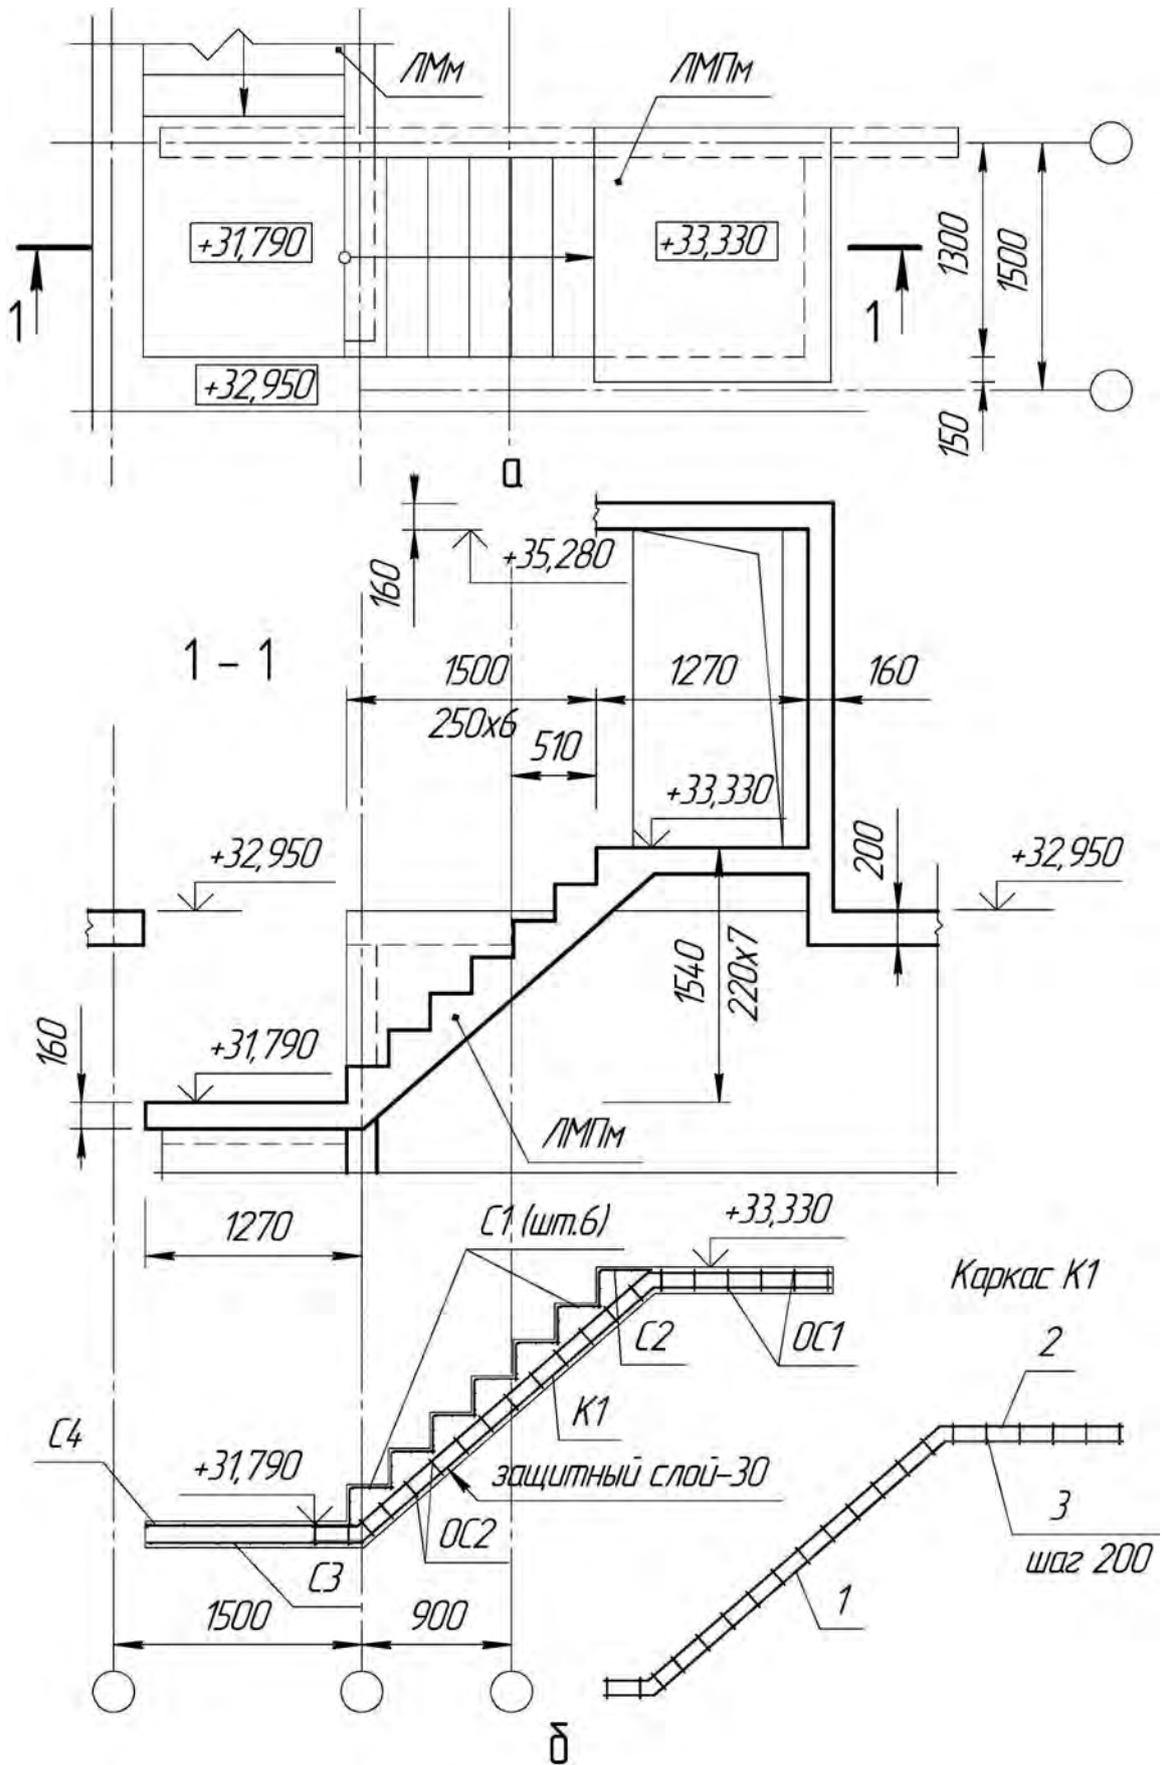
Конструктивное решение монолитной лестницы: а — схема расположения элементов лестницы; б — схема армирования элемента ЛММ
